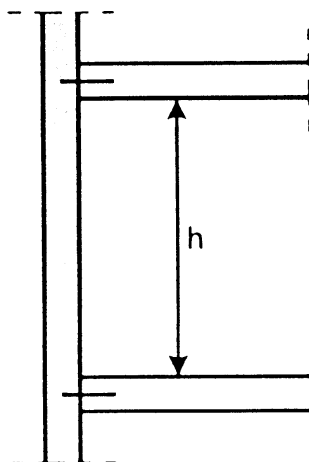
Liaison sans encastrement assurée par les planchers ou la toiture
